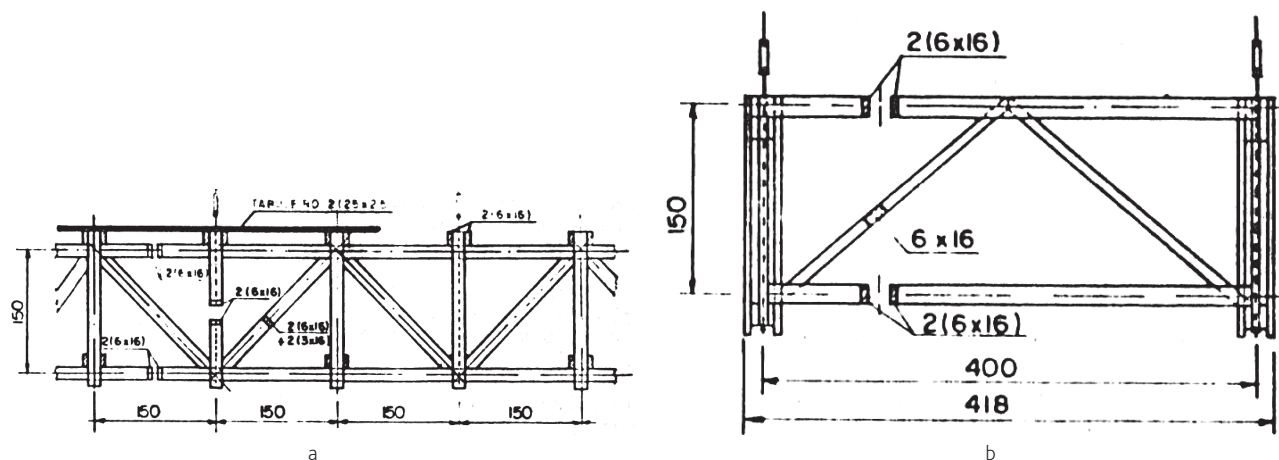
Elementos estruturais de madeira do projeto da estrutura da Passarela Pênsil de Piracicaba: a) viga de rigidez treliçada ($TR1 = TR2$); b) contraventamento transversal das vigas de rigidez (Fonte: Calil Junior; Rocco Lahr; Dias, 1993)
